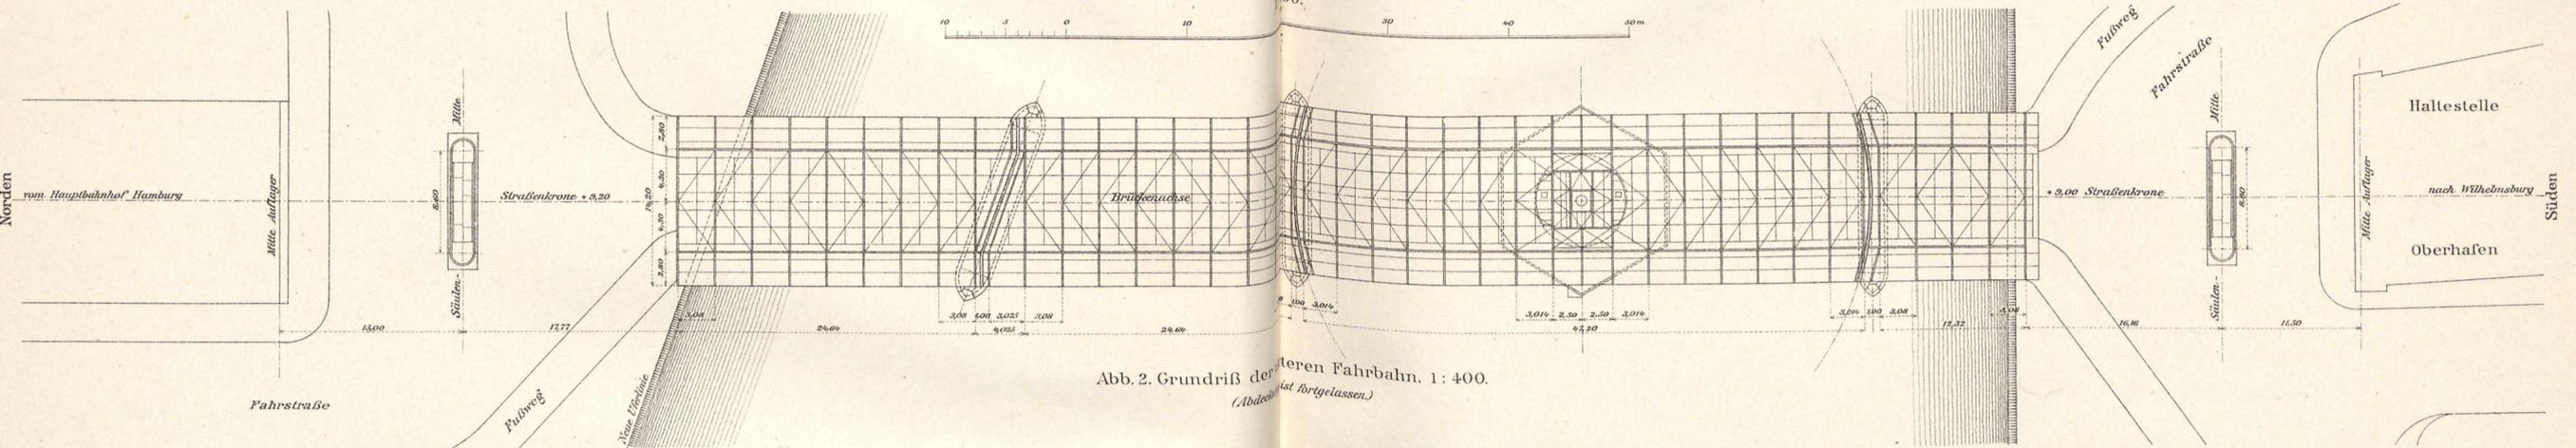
Grundriß der unteren Fahrbahn. 1: 400. (Abdeckung ist fortgelassen.)
